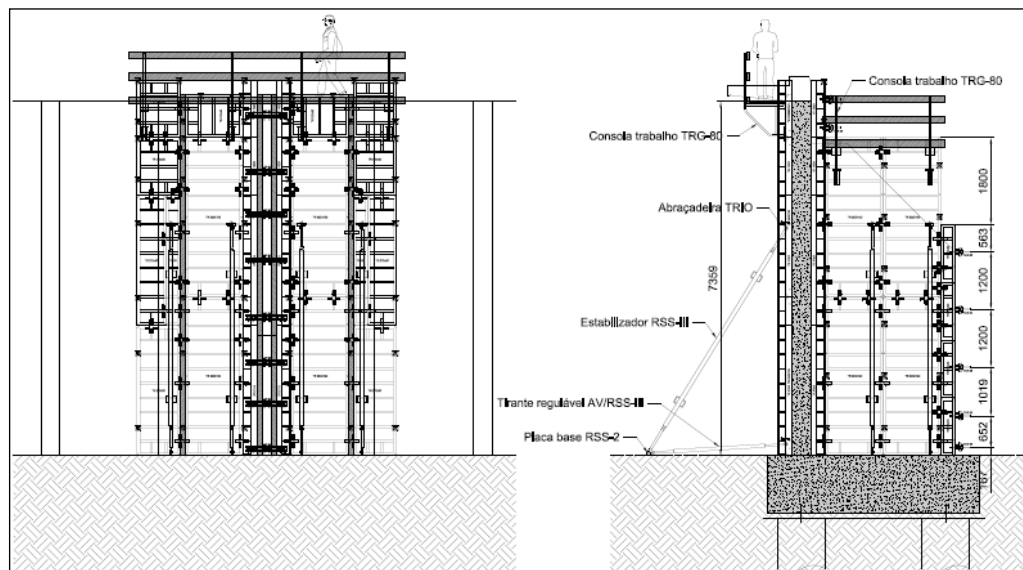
MÓDULO TIPO UTILIZADO NA ELEVAÇÃO DOS ENCONTROS
